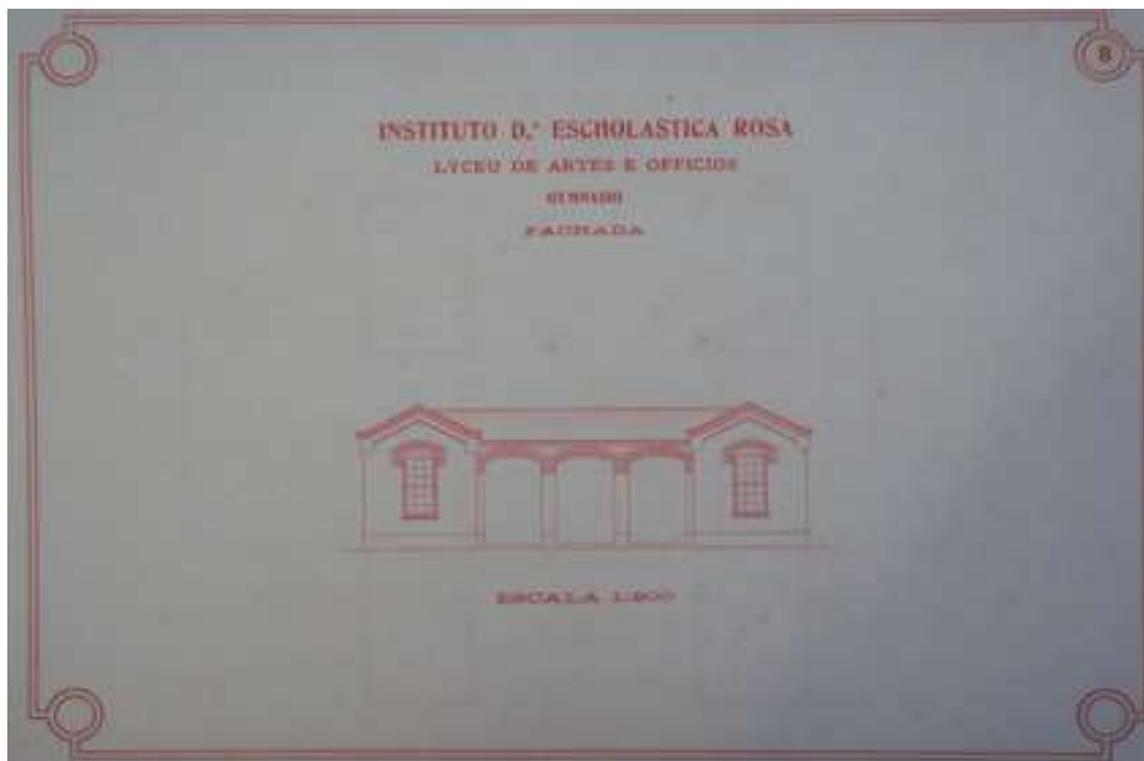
Planta 8 - Fachada do Ginásio. Fonte: Conceição (1908)
